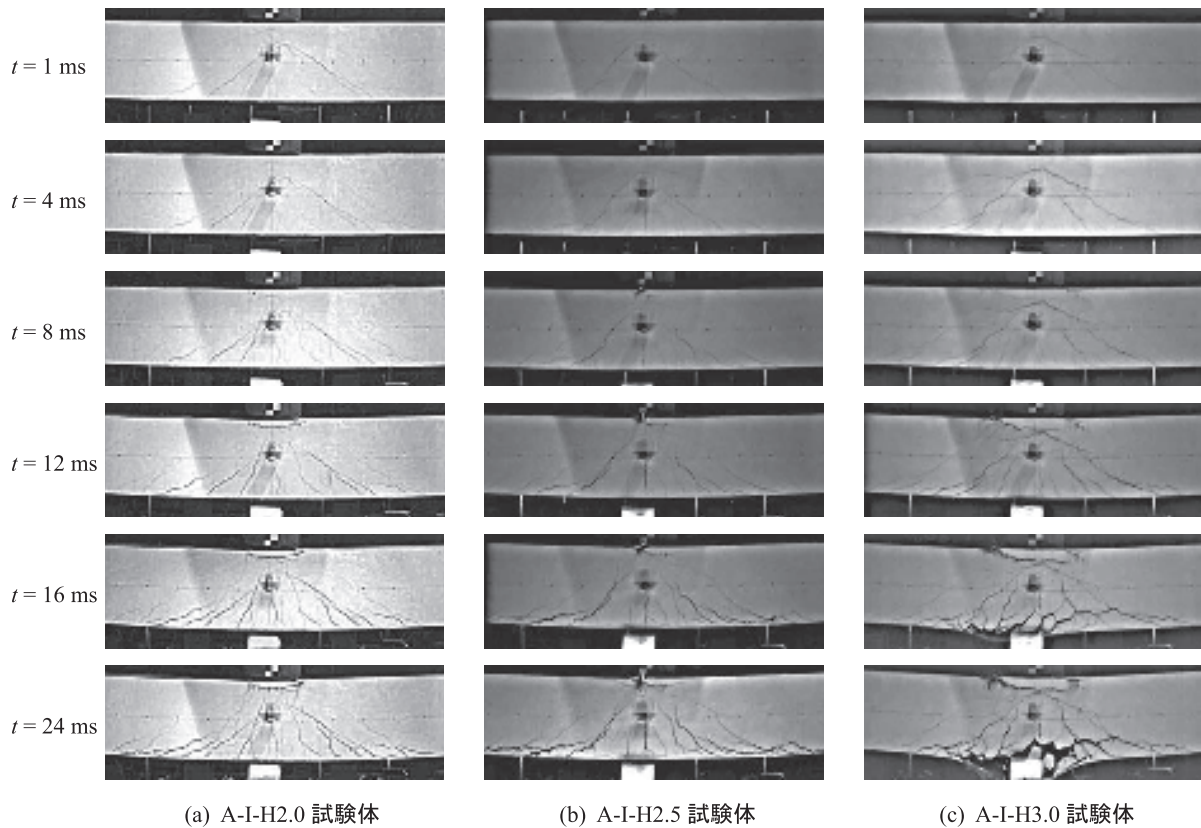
衝撃荷重载荷における A-I 試験体のひび割れ性状
